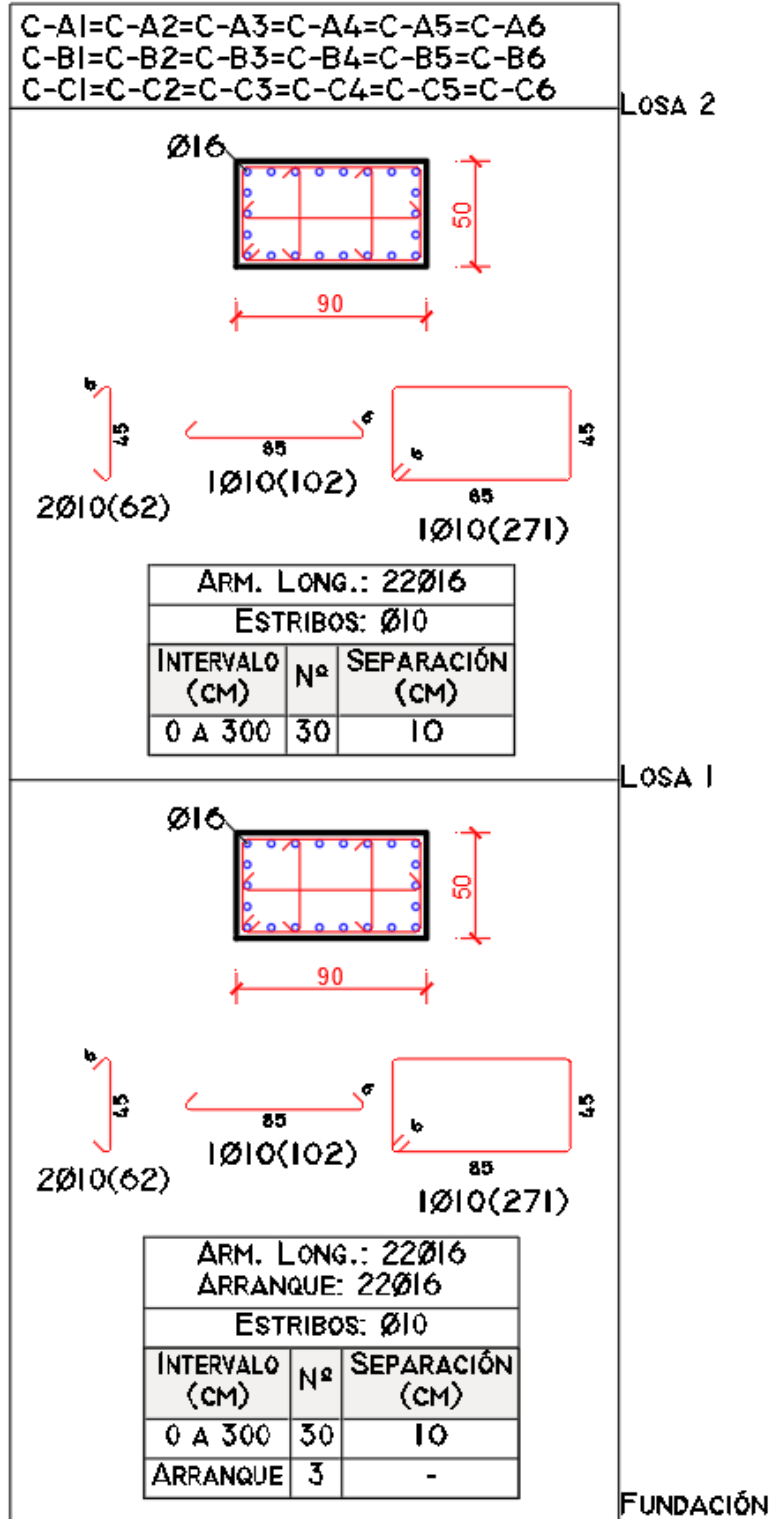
Detalle de Refuerzo Columnas, de Fundación a Losa 2, Estructura [7N-EE].
